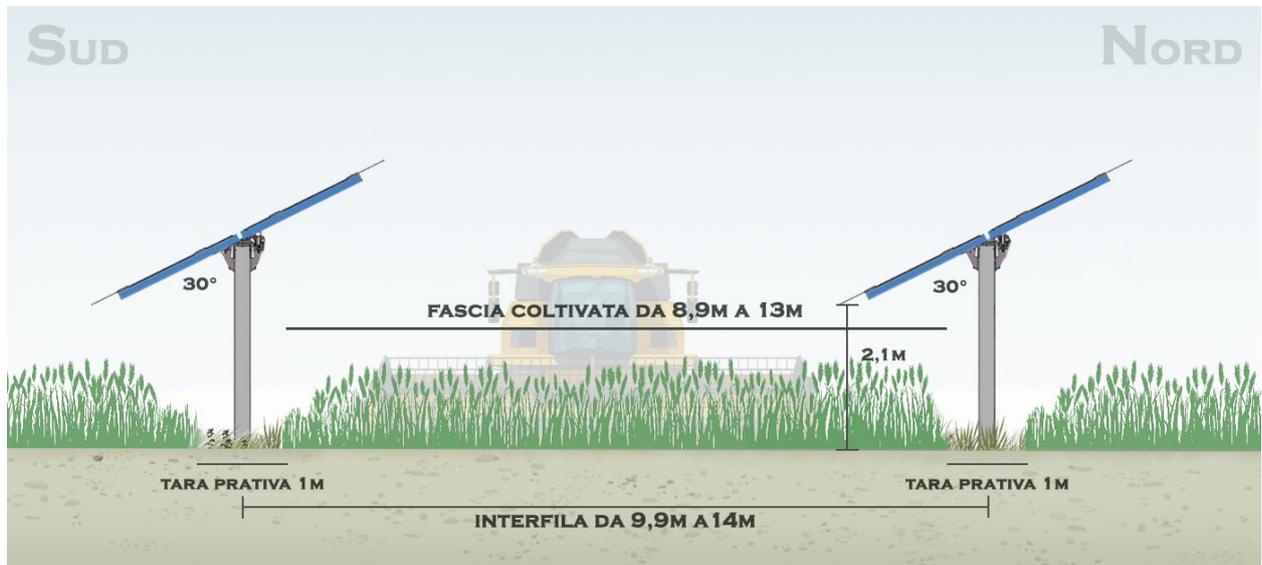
Sezione tipologica di campo con installazione di tipo fisso.
